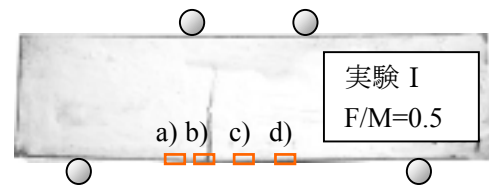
実験 I の曲げ供試体のひび割れ観察
